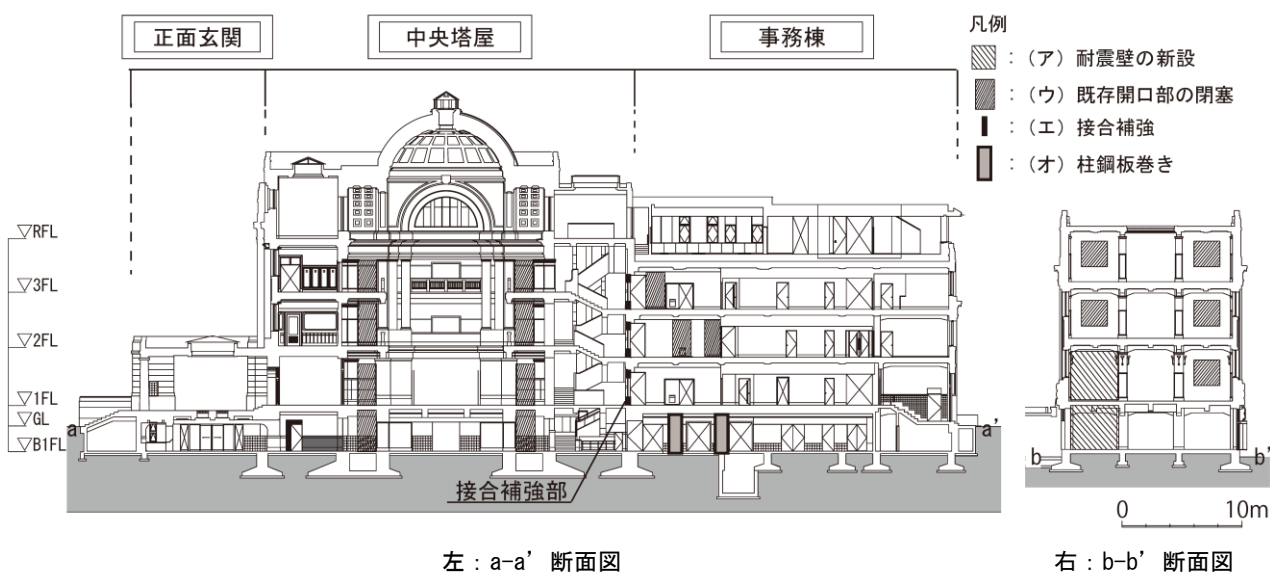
建物内の補強位置 断面図（竣工中央断面図及び南翼断面図を加工の上加筆）
